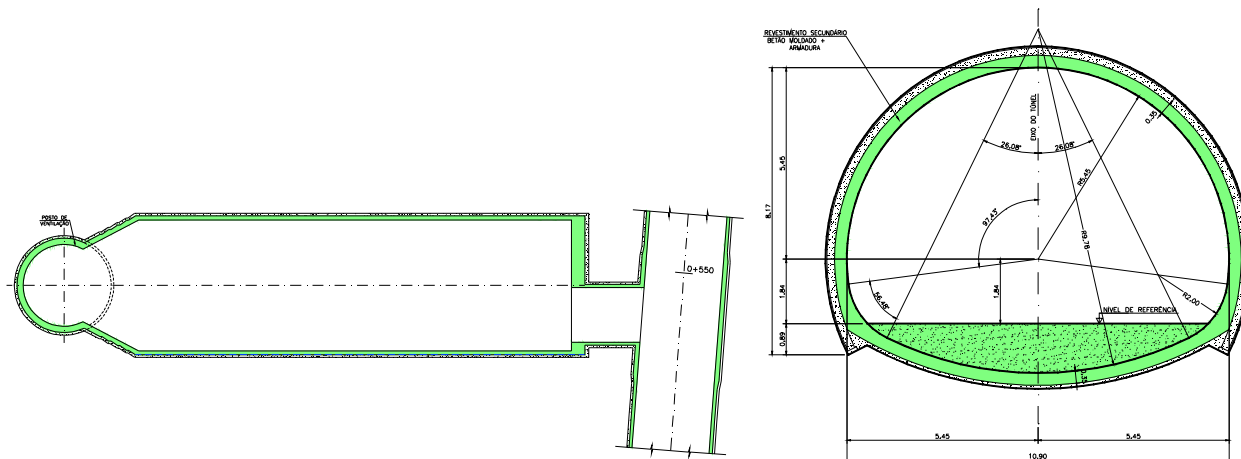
Túnel das Salas de Ventilação – Planta e Secção Transversal
